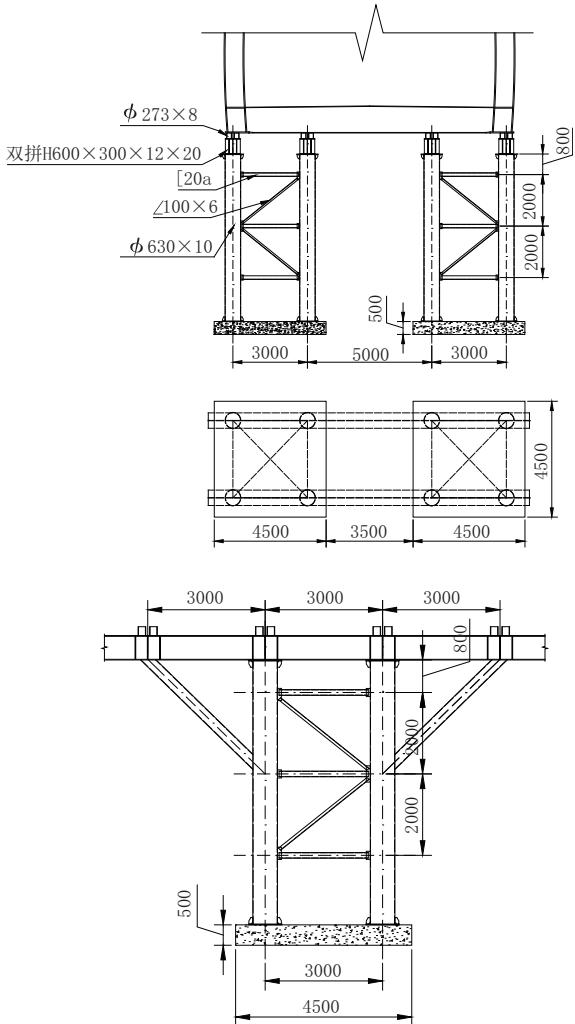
主桥边跨陆地临时支墩横断面图(单位:mm)
